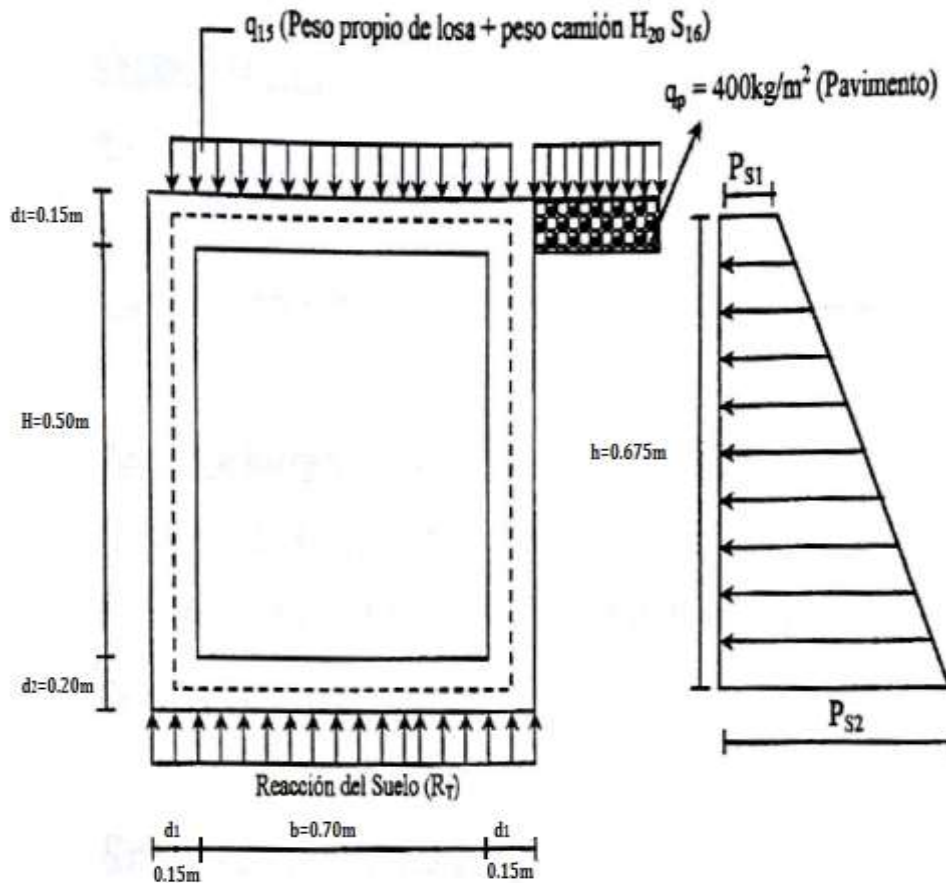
Sistemas de cargas en las alcantarillas. (Fuente: Elaboración propia)
